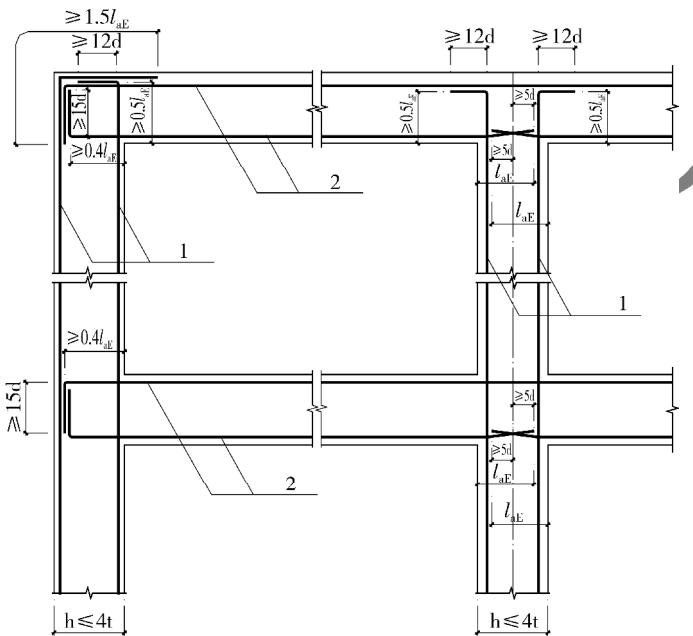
节点区墙、梁纵向钢筋锚固大样
